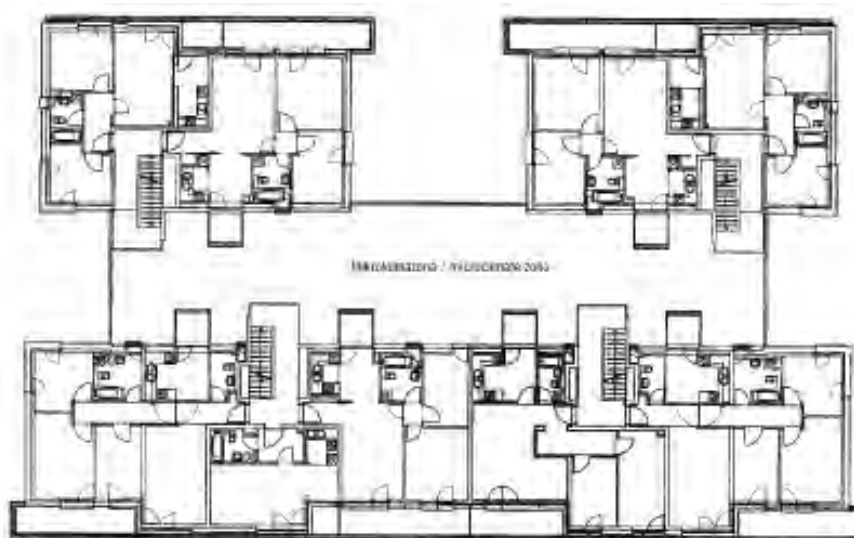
Pianta del Complesso Holzstrasse Building Complex a Linz, progetto arch. Thomas Herzog, 2001 (Fonte: Studio Herzog).
